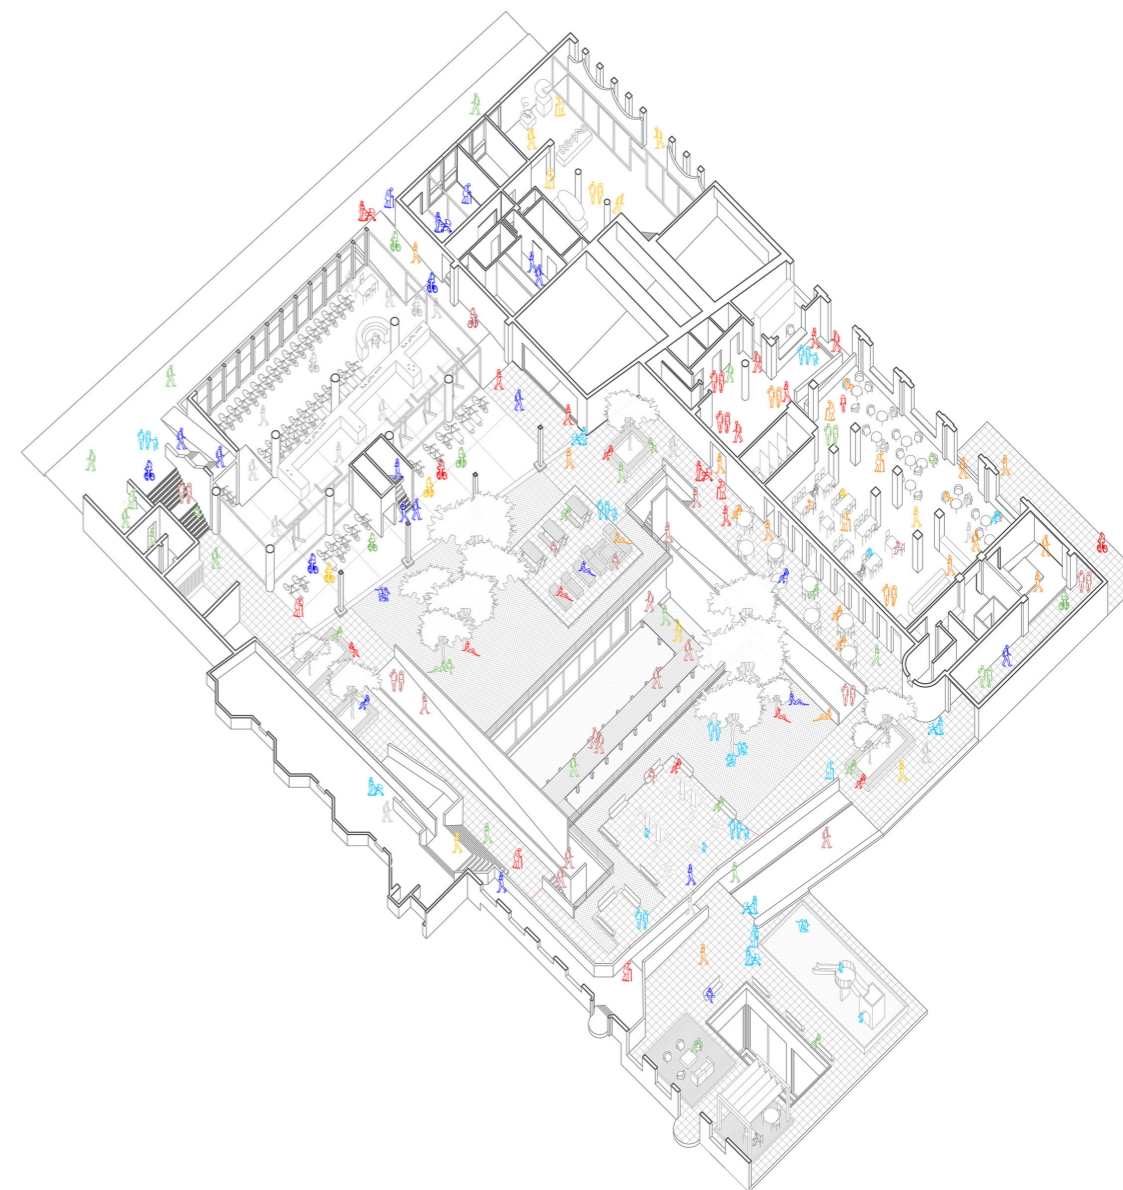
Rez-de-chaussée, mise en valeur de la mixité
